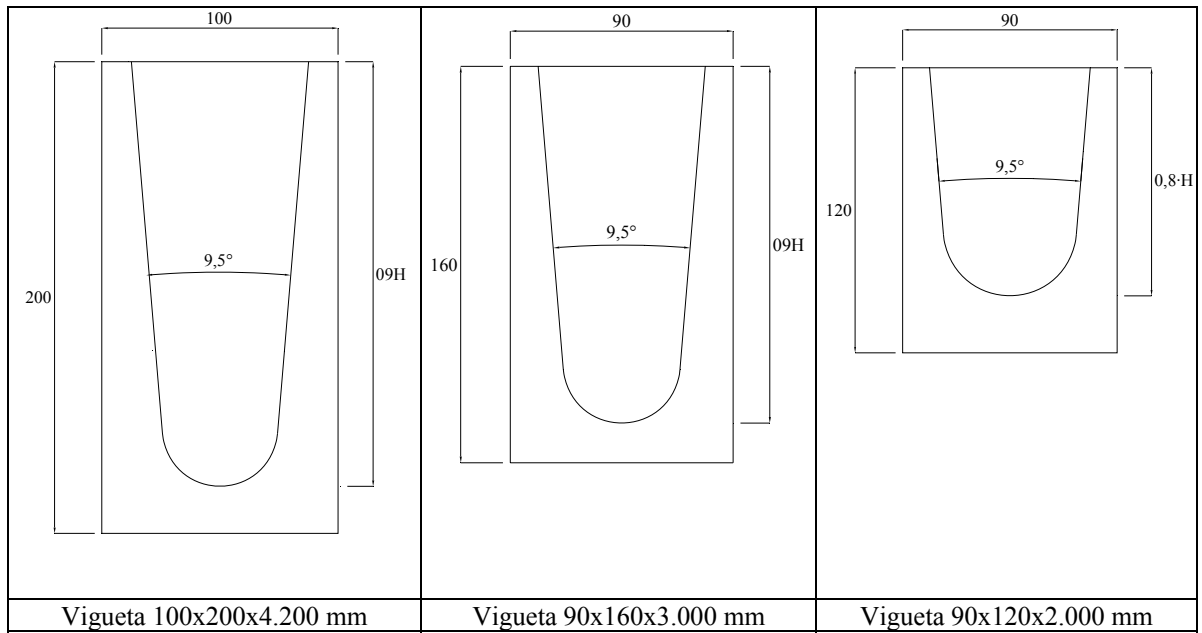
Secciones de viguetas analizadas con la geometría de la espiga sobre la testa.
